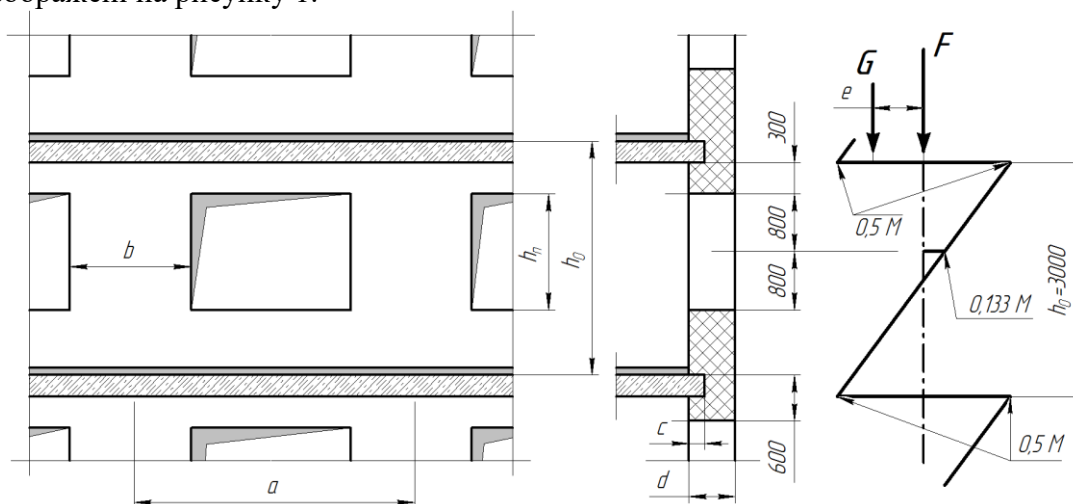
Конструктивна і розрахункова схема зовнішньої несучої стіни
